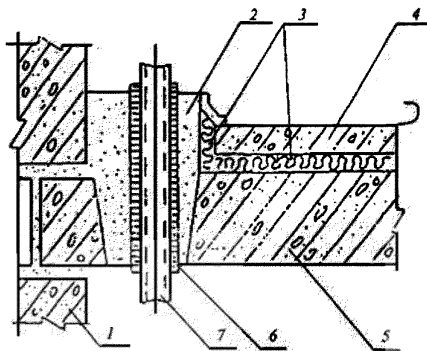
Схема конструктивного решения узла пропуска стояка отопления через междуэтажное перекрытие:
